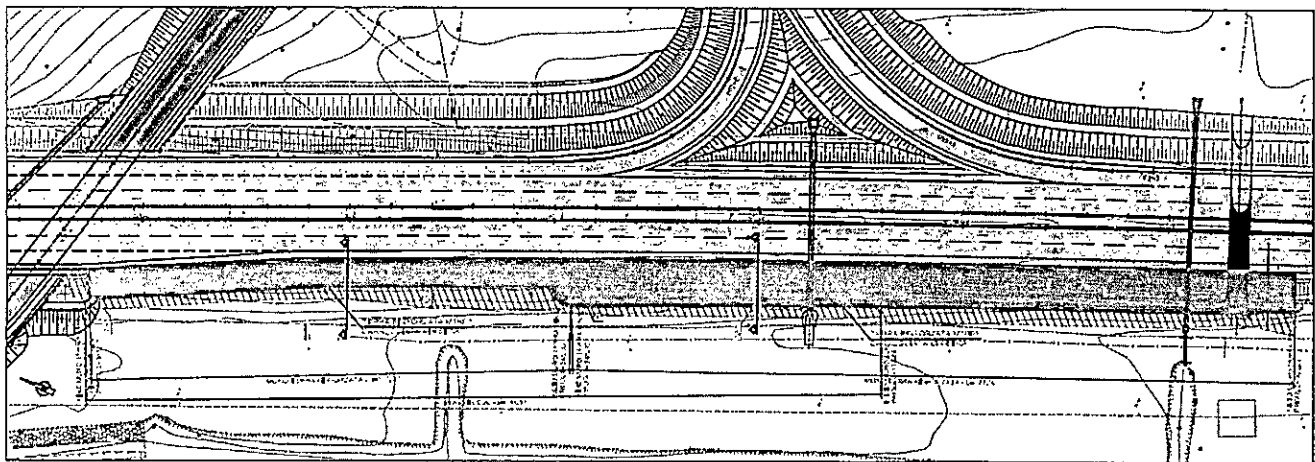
Stralcio planimetrico – Progetto Esecutivo – Terra Rinforzata TR1-TR2
